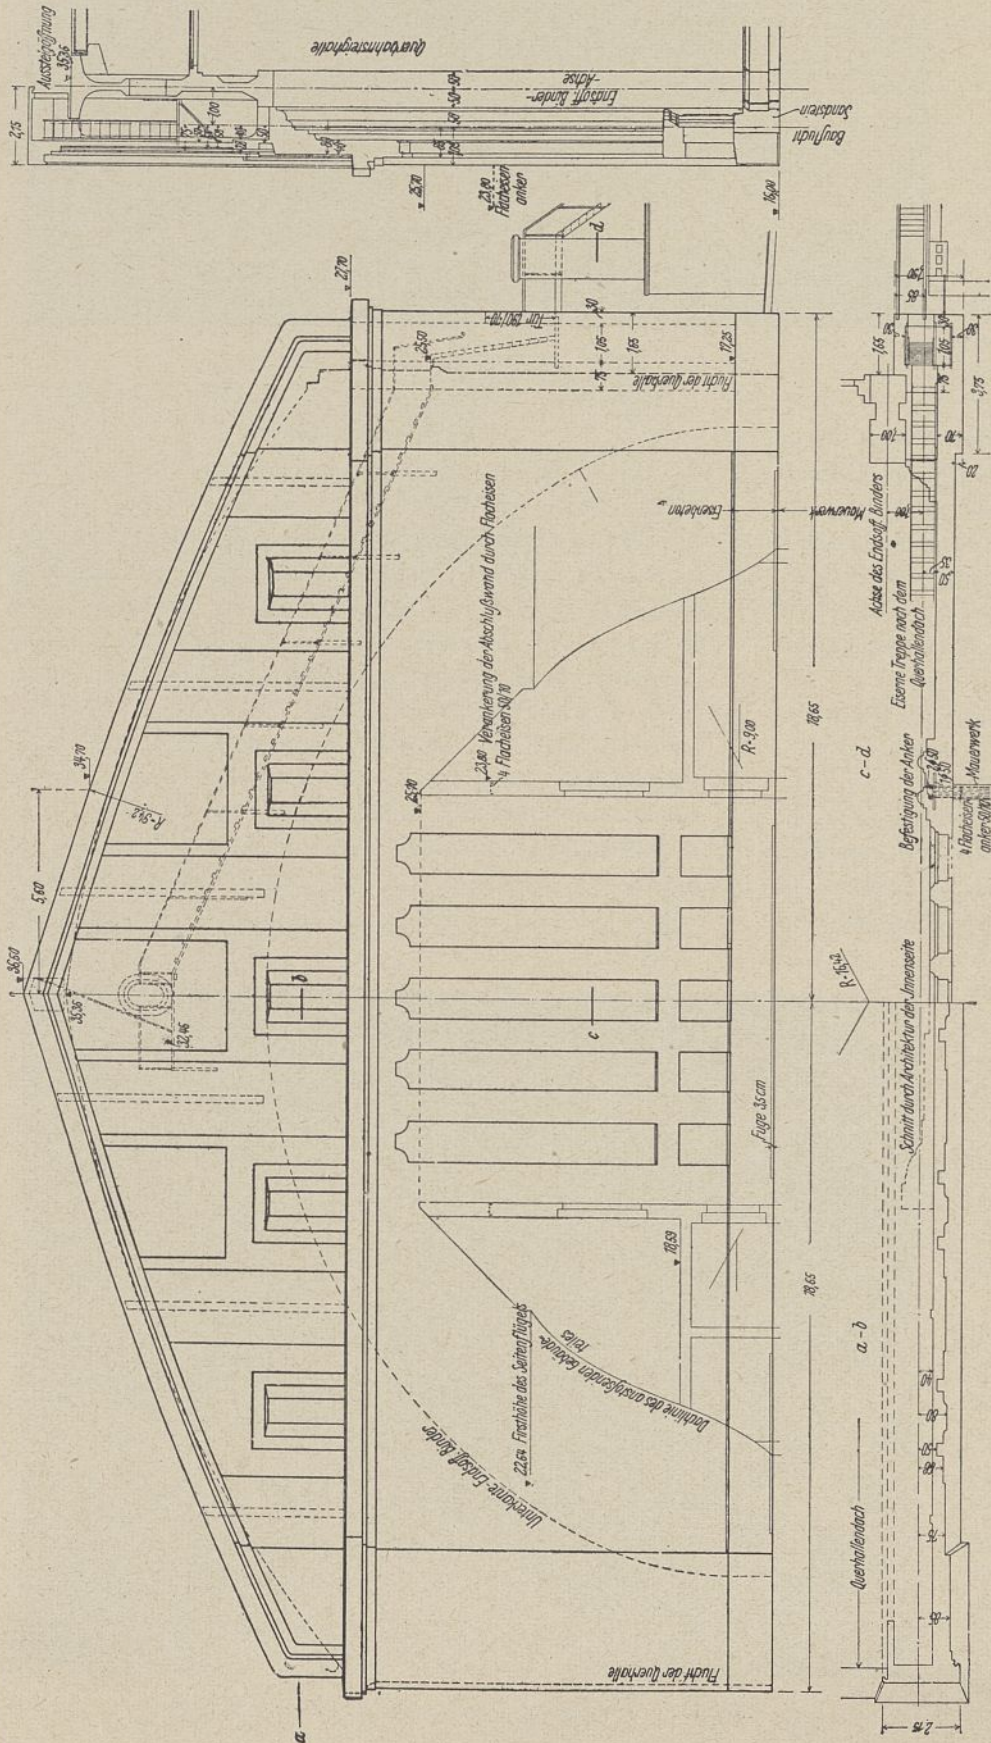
Äußere Ansicht der Giebelabschlußwand (mit eiserner Treppe nach dem Hallendaub). Maßstab 1 : 200.
